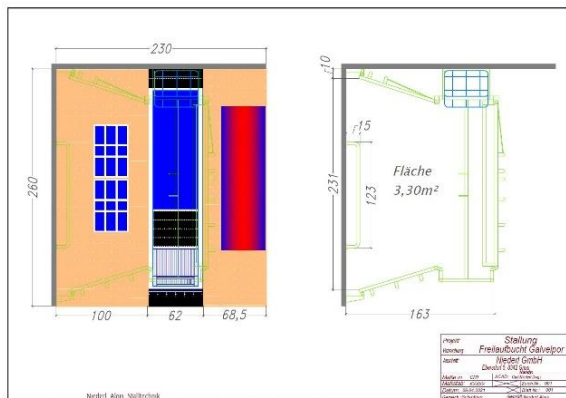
Detailskizzen der Multi-Lib Laterale Abferkelbucht mit integriertem Hubboden Cosy – S im Grundriss, © Niederl GmbH
